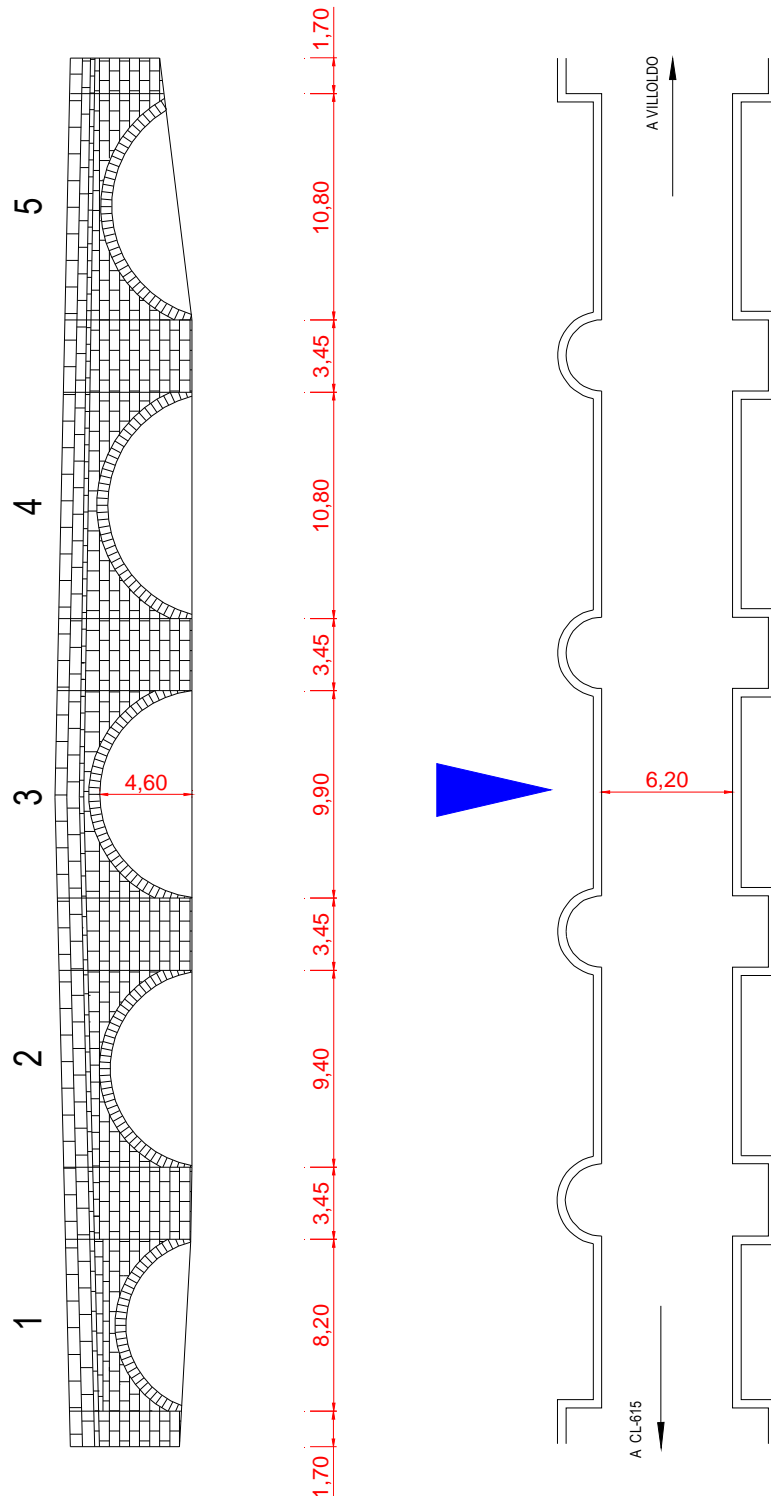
Dibujo de planta y alzado del puente en Villoldo.
